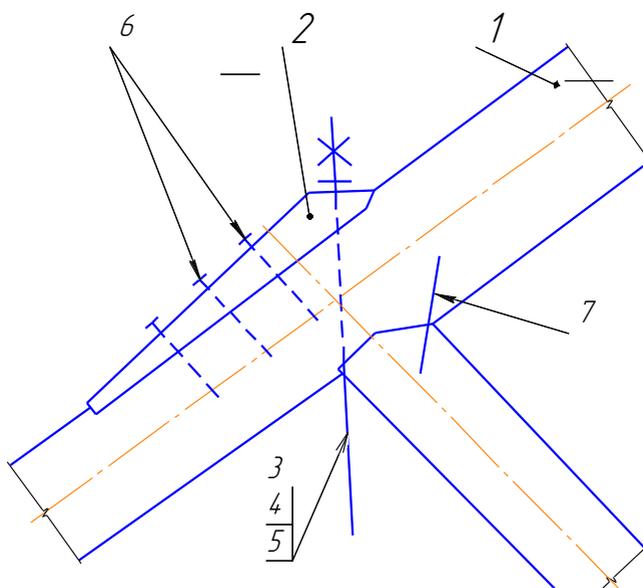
Простейшие конструктивные элементы, используемые для скрепления брёвен и брусьев: 1 – верхний пояс; 2 – накладка; 3 – тяж; 4 – гайка; 5 – шайба; 6 – гвозди; 7 – скоба
